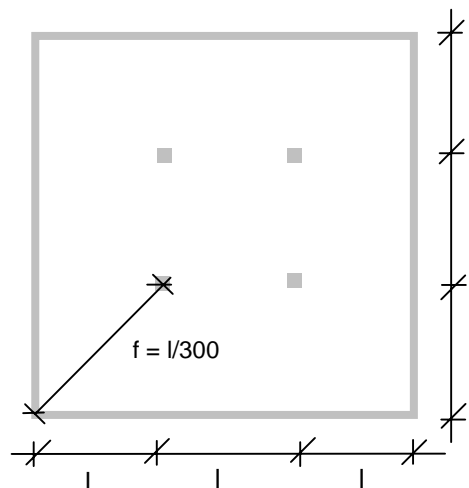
Grundriss für das Berechnungsbeispiel
